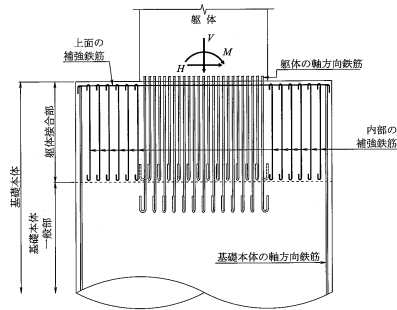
橋脚と大口径深礎との接合部の配筋標準図
